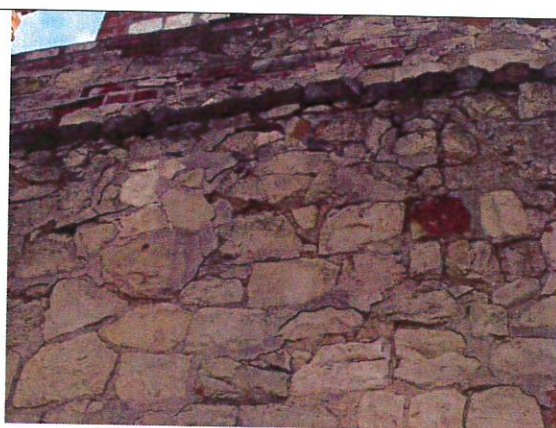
/B. Widok muru i korony od strony wewnętrznej
